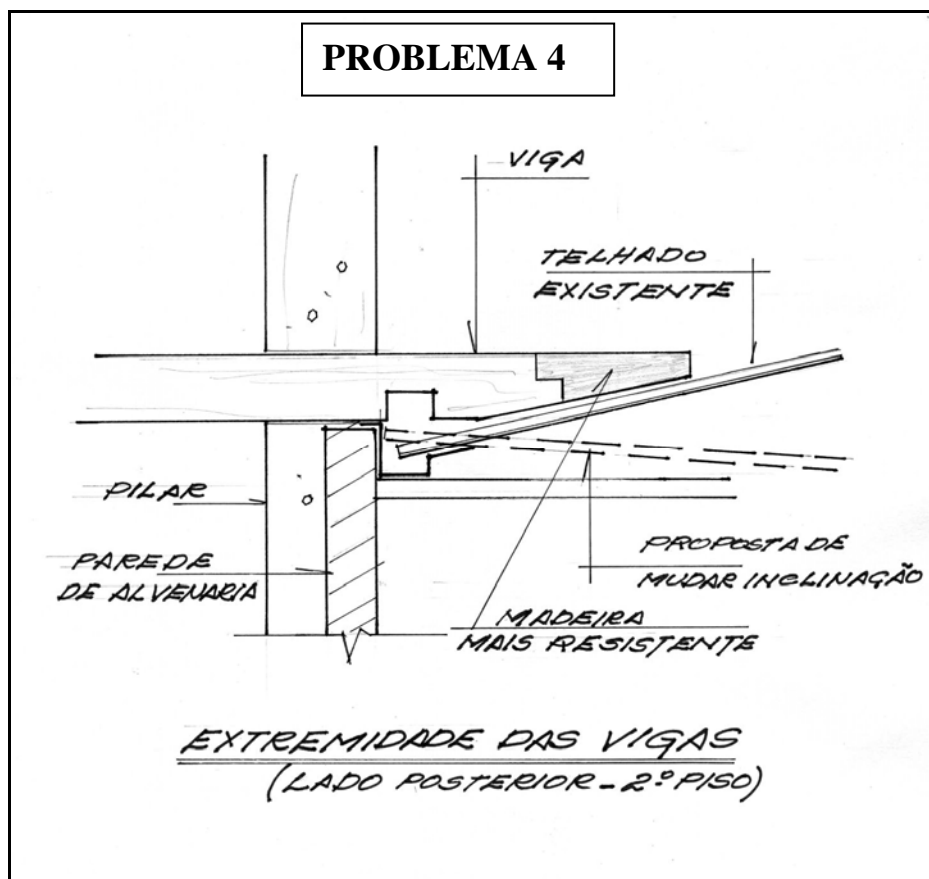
Deterioração da extremidade da viga na varanda posterior
